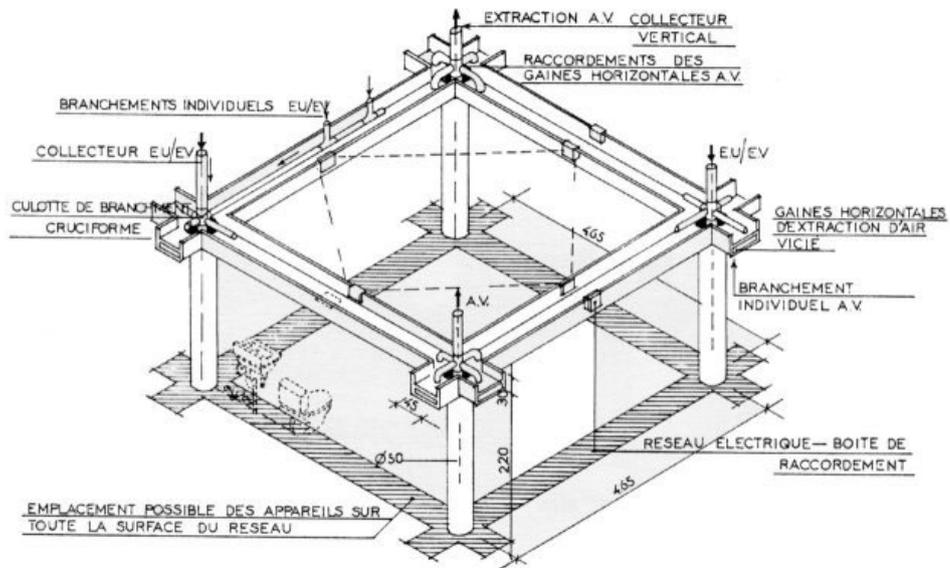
schéma de la structure poteaux-poutres des Marelles
